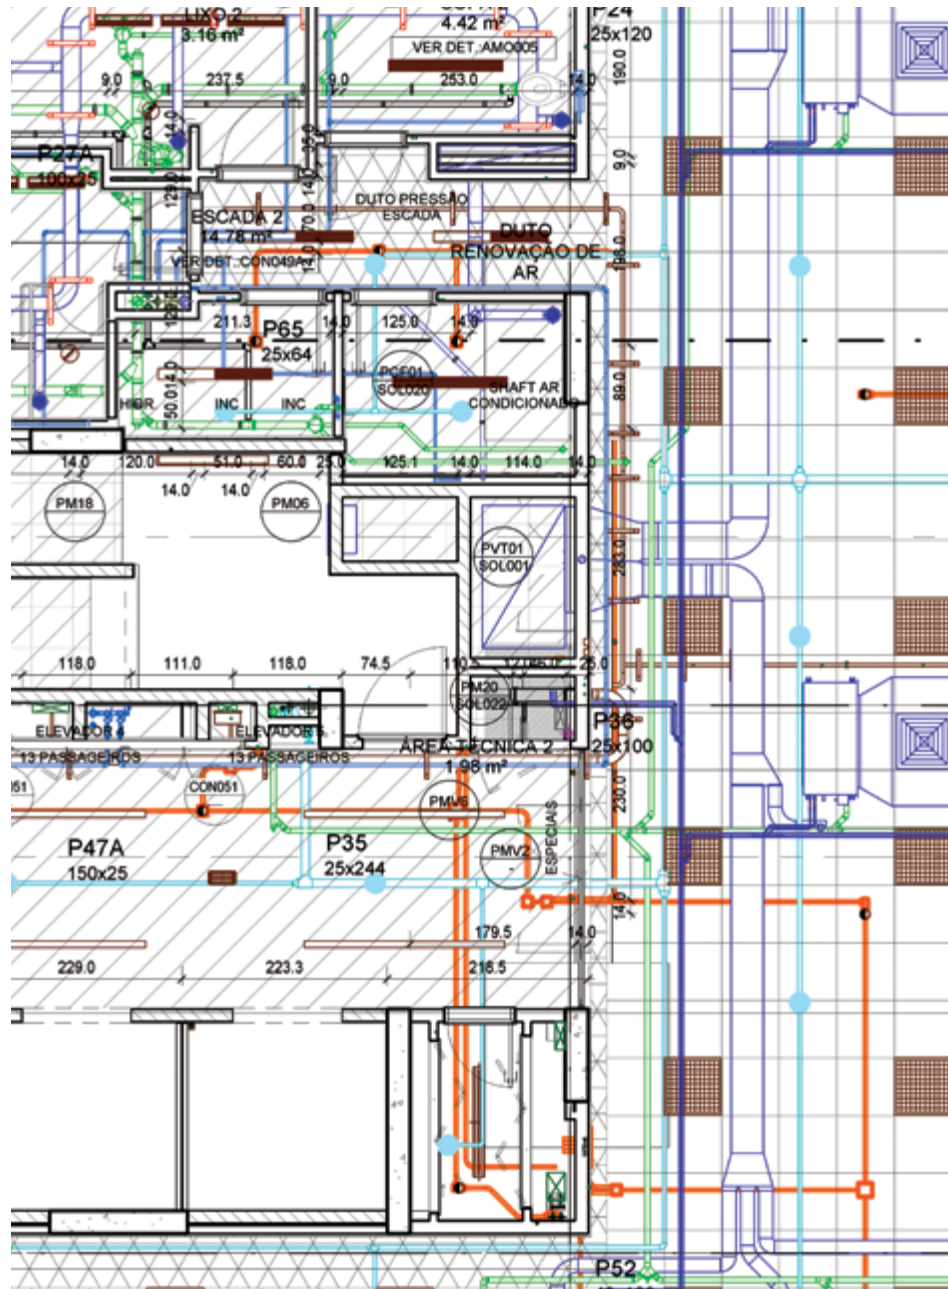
Trecho de planta de executivo de arquitetura, com dados da estrutura destacados.
